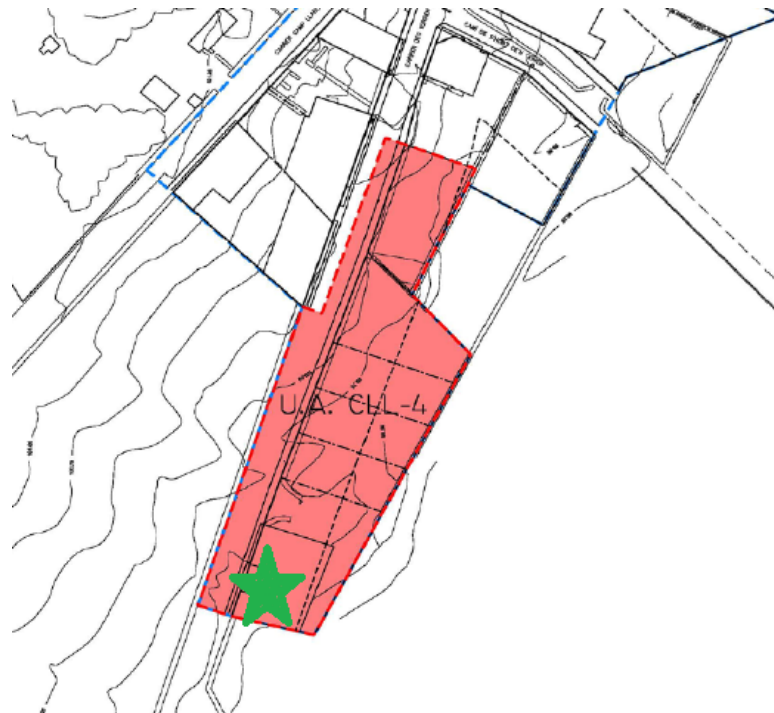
Ubicación (estrella verde) edificación existente a mantener
